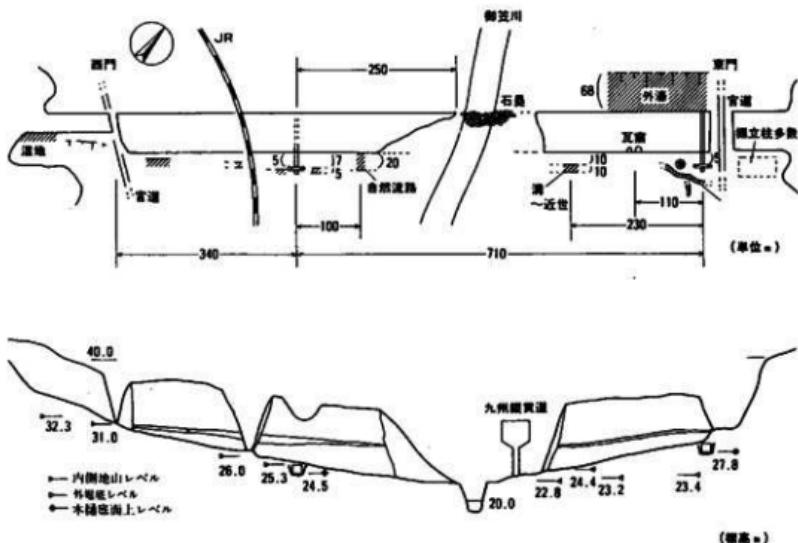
水城跡の平面図（上図）および推定断面図（下図）
